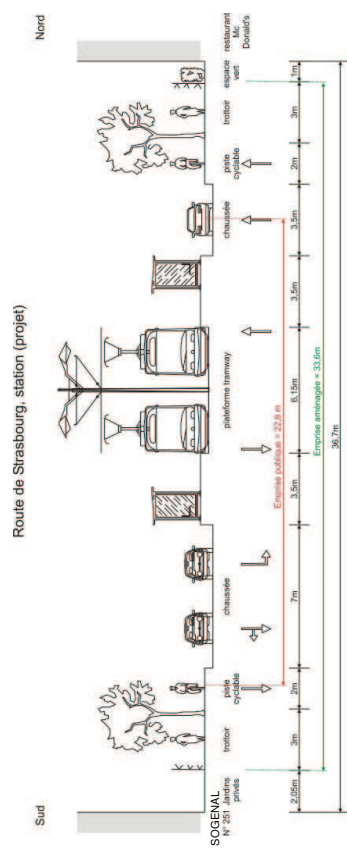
Situation projetée. Coupe d'insertion sur la route de Strasbourg
